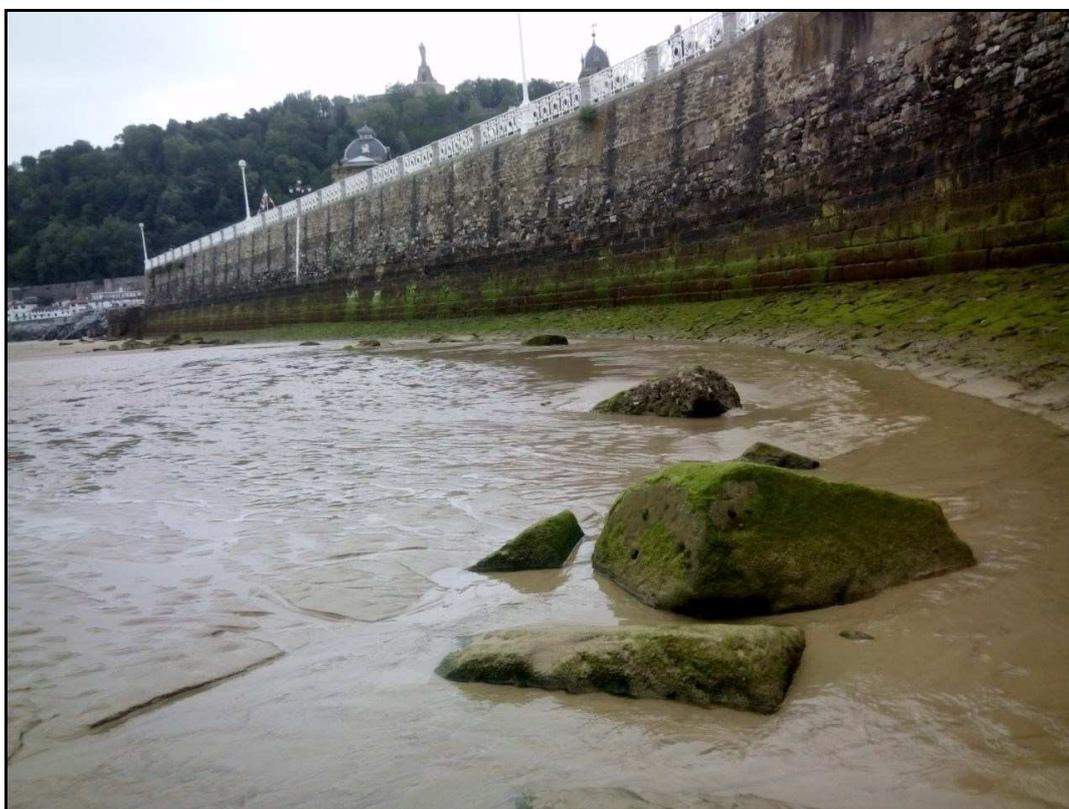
Zapata y escollera a pie de muro en Alderdi-Eder.
